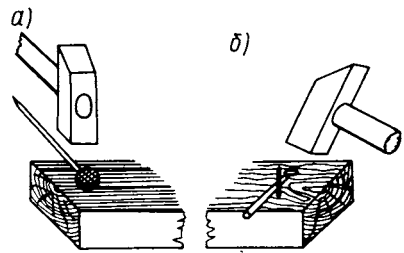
Забивка шляпки в древесину (а) и загибание выступающего конца (б)
